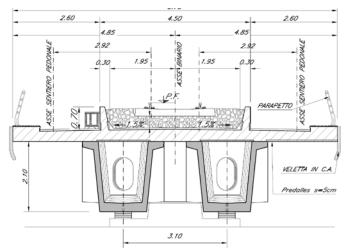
Sezione trasversale campate in c.a.p. L=25 m
